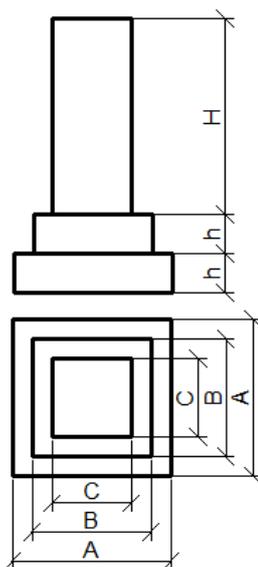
Расчетная схема фундамента, бетонируемого методом термоса
